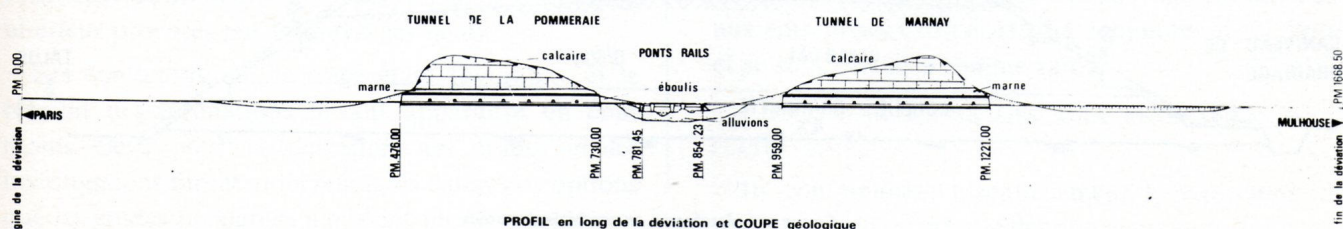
Tunnels de La Pommeraie et de Marnay. Profil en long et coupe géologique.
